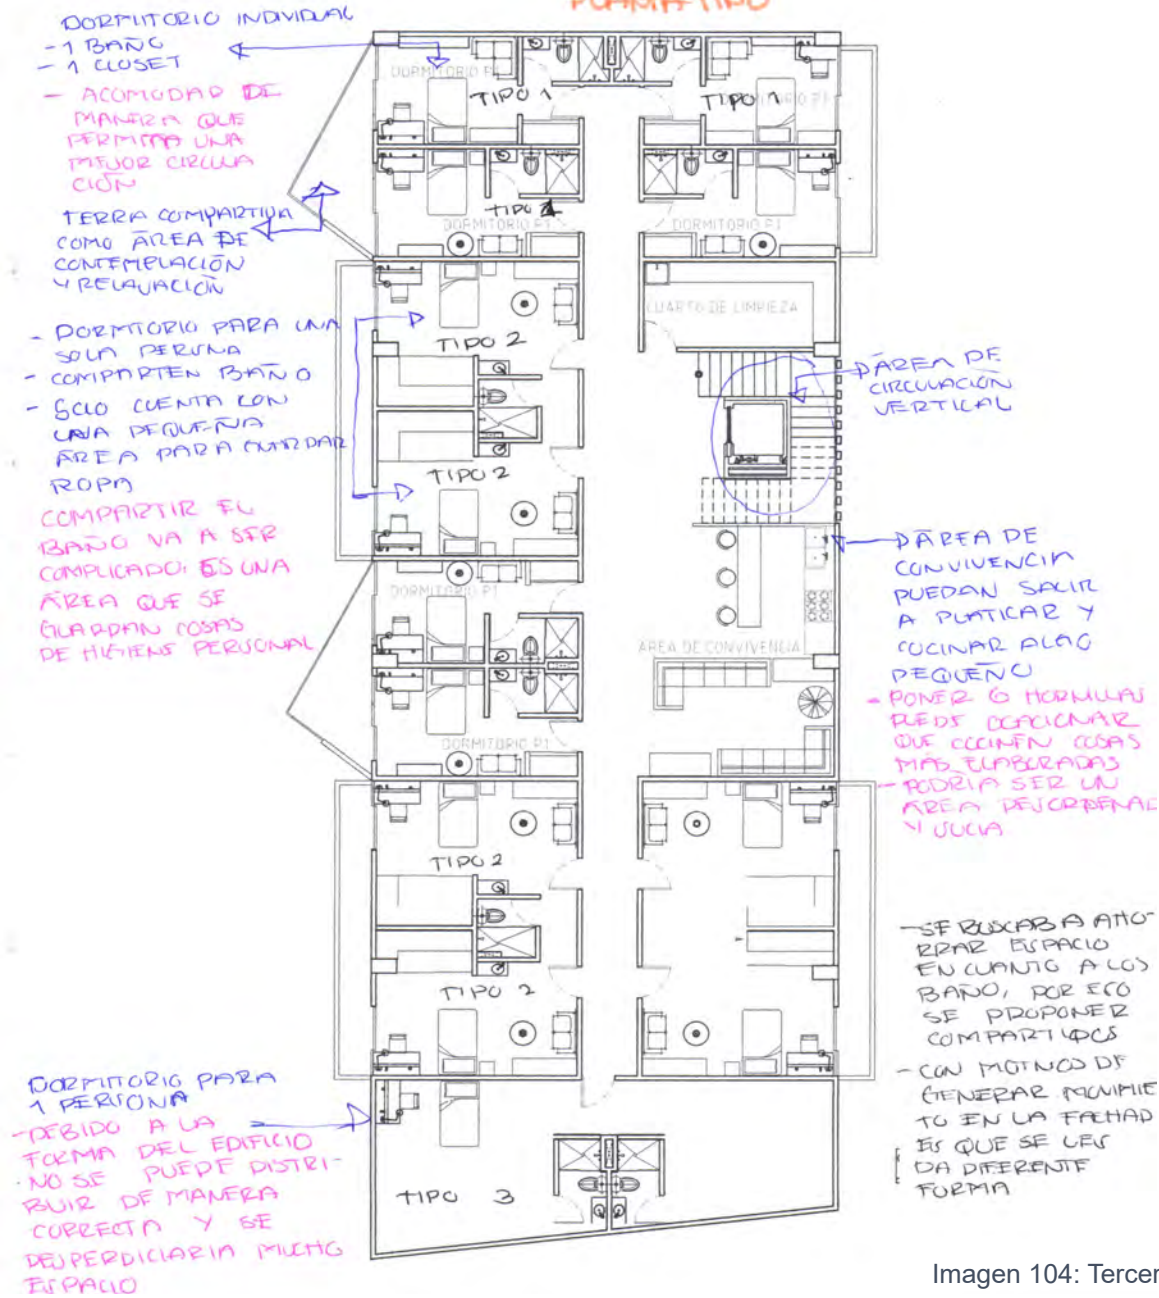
Tercer acercamiento a la residencia Planta tipo
